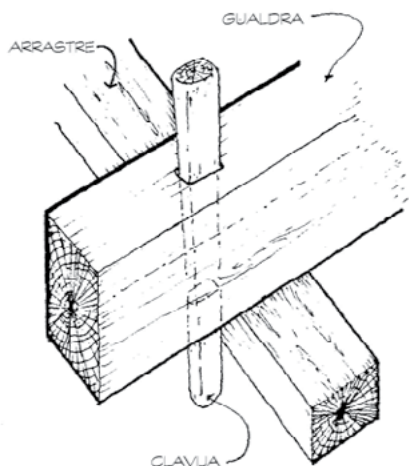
Amarre enclavijado. Detalle en el templo de Santa Ana Chapitiro. Esquema elaborado por Luis Alberto Torres. Fotografía del Archivo Torres Salomao.
